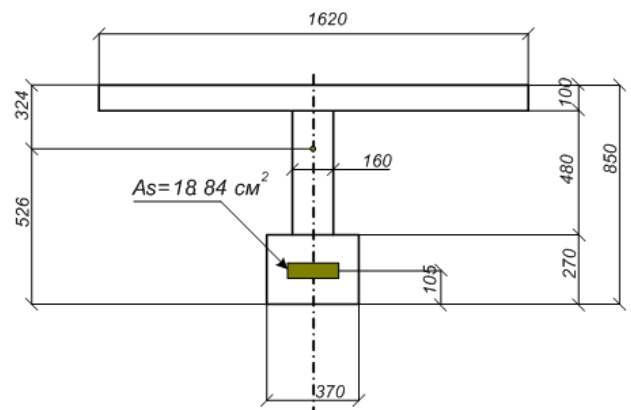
Приведений переріз головної балки прогонової будівлі довжиною 14,06 м
